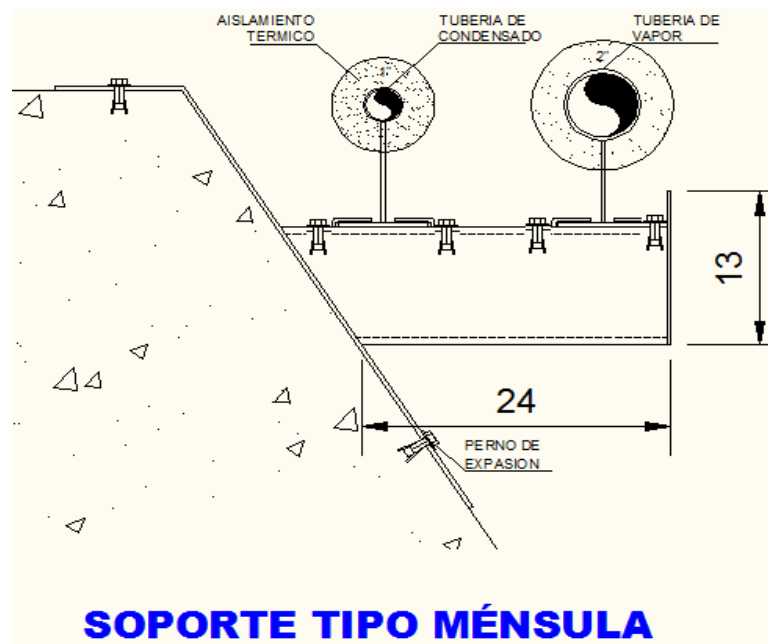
INSTALACIÓN DE TUBERÍA EN CANAL DRENAJE
